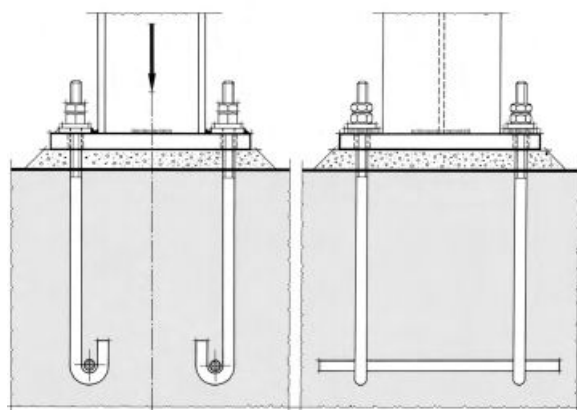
Ancoraggio pilastro in acciaio su fondazione in calcestruzzo prefabbricata.¹⁵
